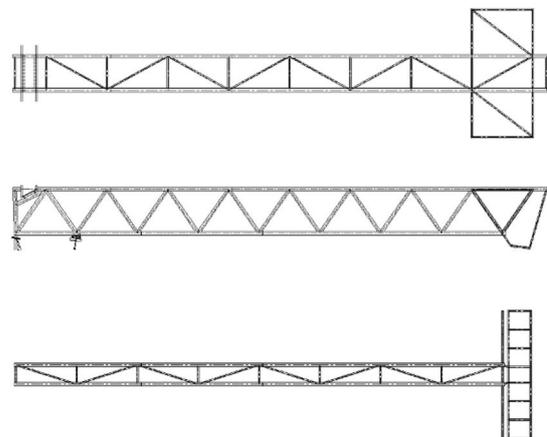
Vistas en planta de plano superior, alzado lateral y planta de plano inferior de los módulos tipo. Fuente: elaboración propia.
